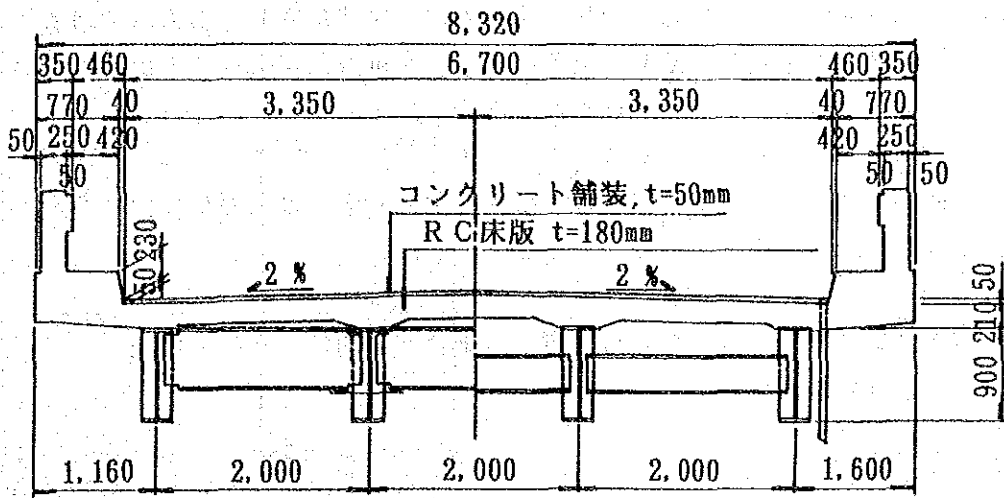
上部工標準断面図 (H形鋼合成桁)
